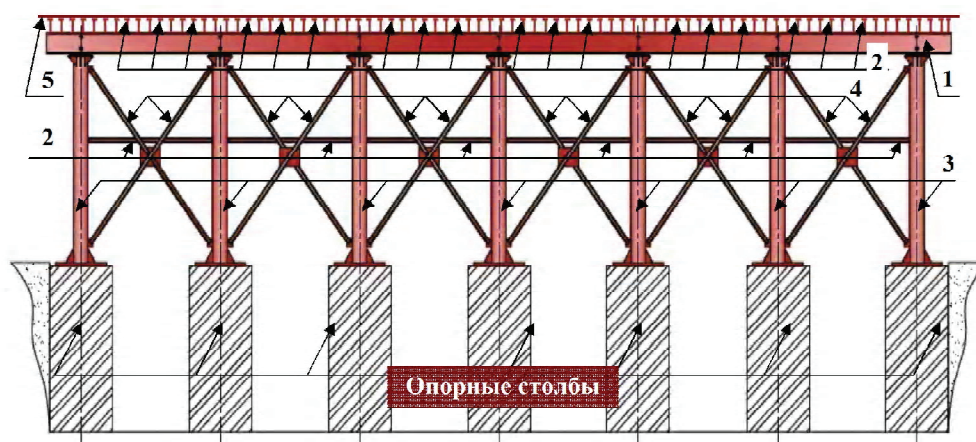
Конструктивная схема дна стекловаренной печи (продольный разрез): 1 – продольные балки; 2 – поперечные балки; 3 – колонны дна; 4 – продольные связи; 5 – металлический плоский лист; 6 – площадки для обслуживания.
